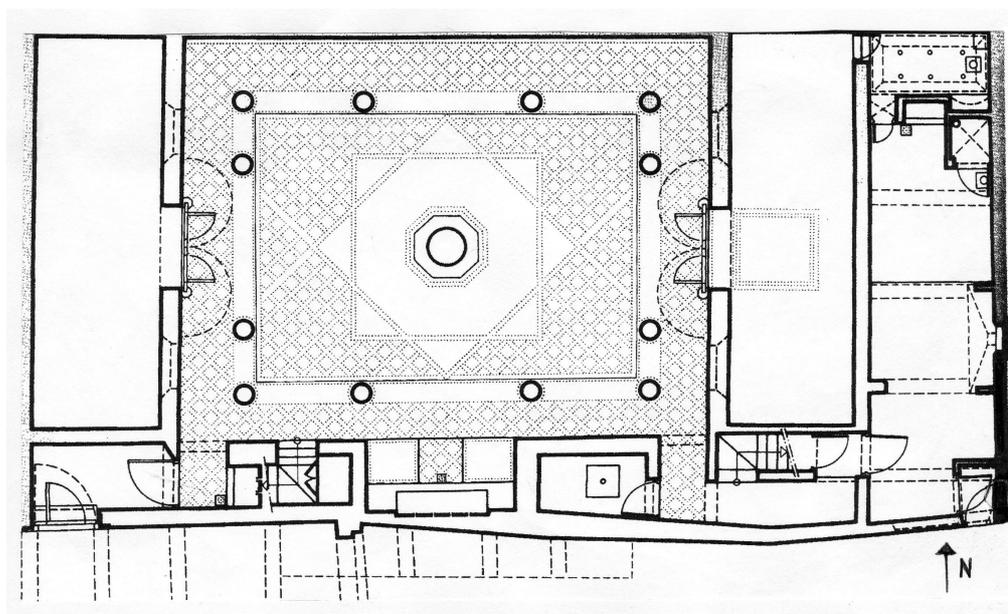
Grundriss des Hauses *Smires* in *Fās
